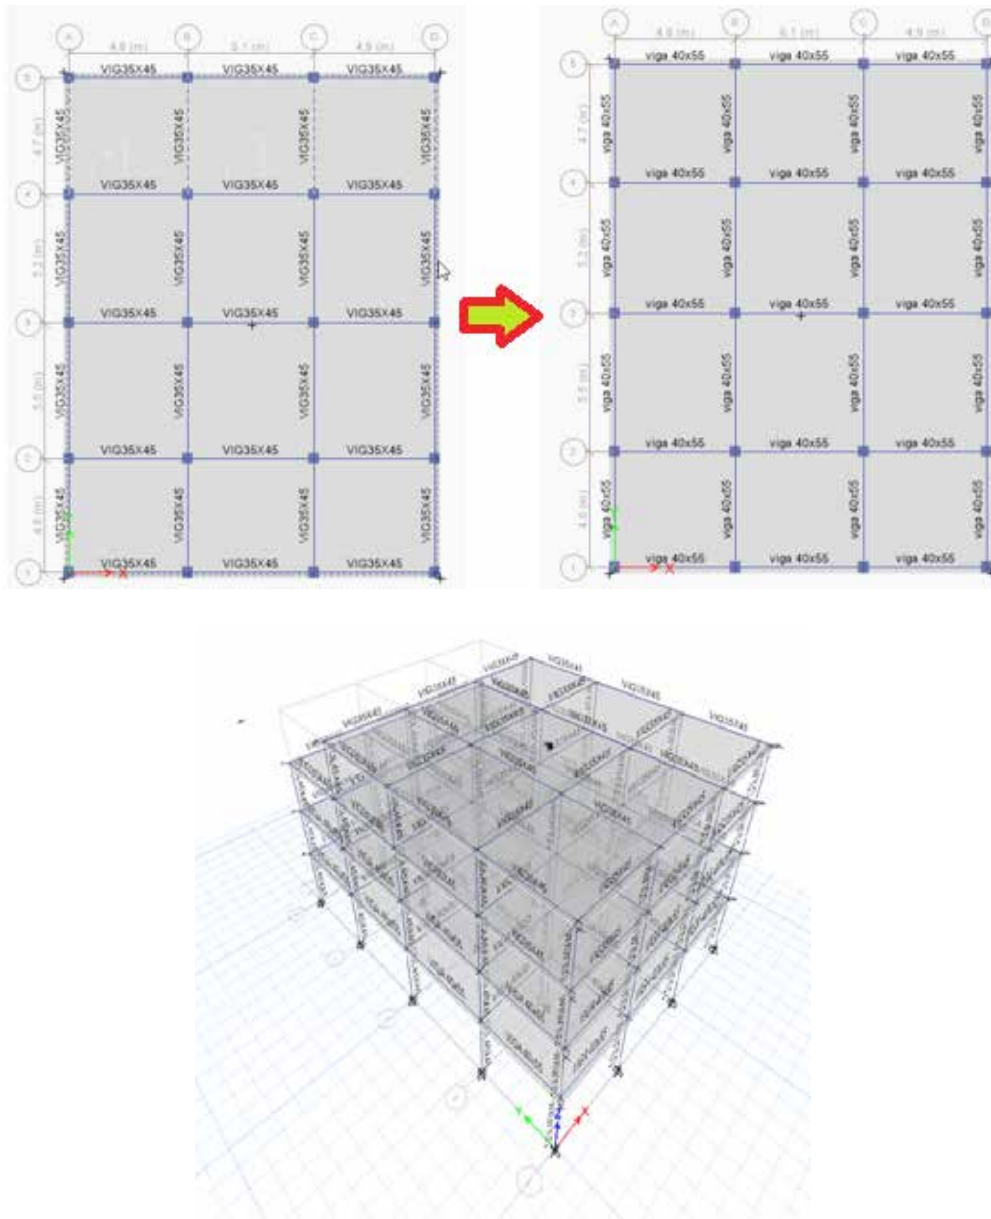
Cambio de sección a 40x55 de las vigas de los dos primeros pisos.
